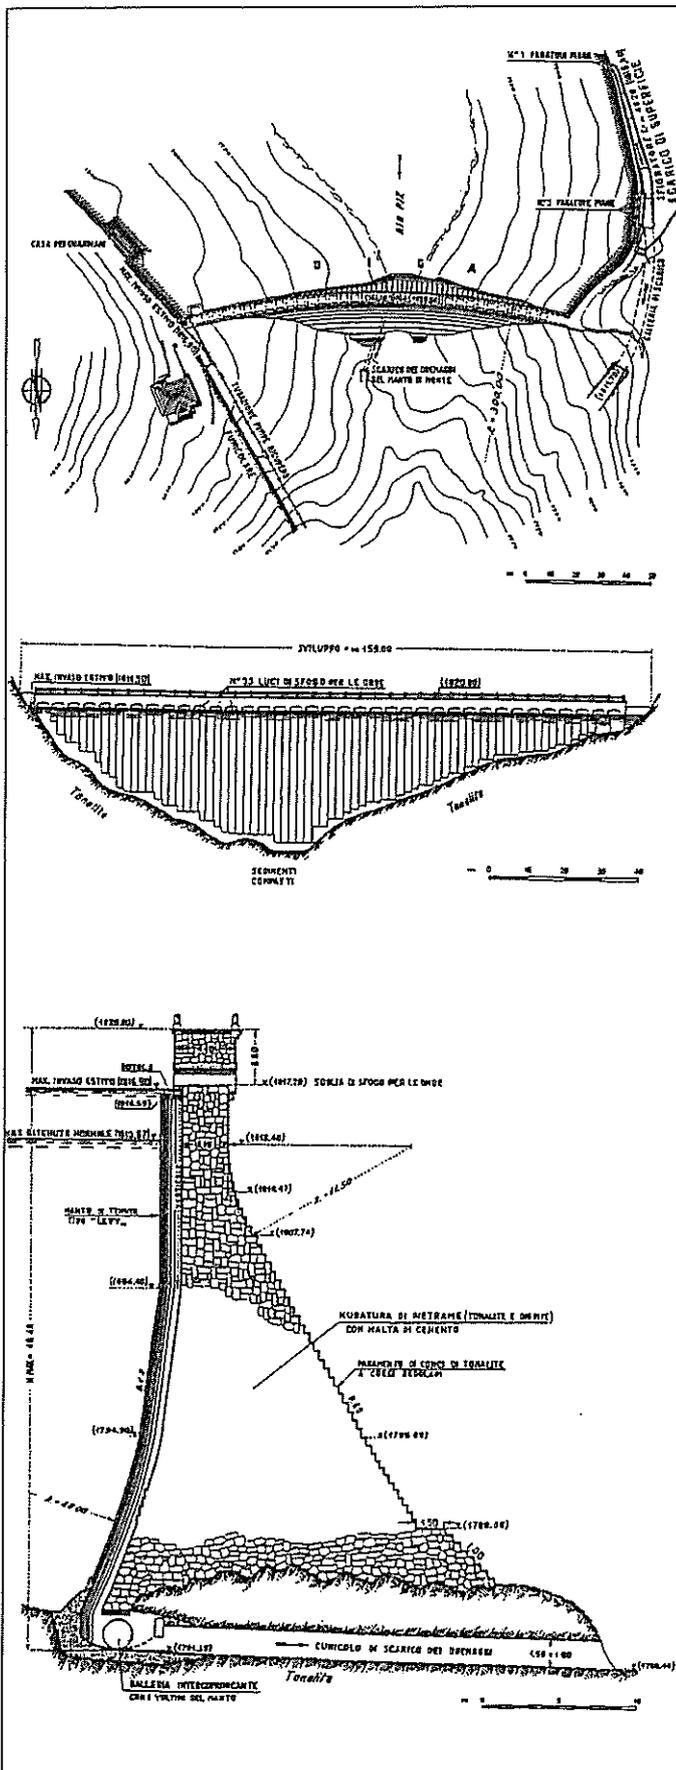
Diga Lago d'Arno: Planimetria - Vista da monte - Sezione tipo.
